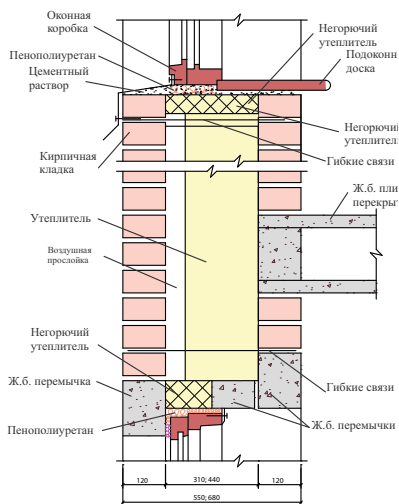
Надоконный и подоконный узлы наружной стены из кирпичной кладки толщиной 55, 68 см с вертикальными кирпичными диафрагмами (без подоконной ниши)
